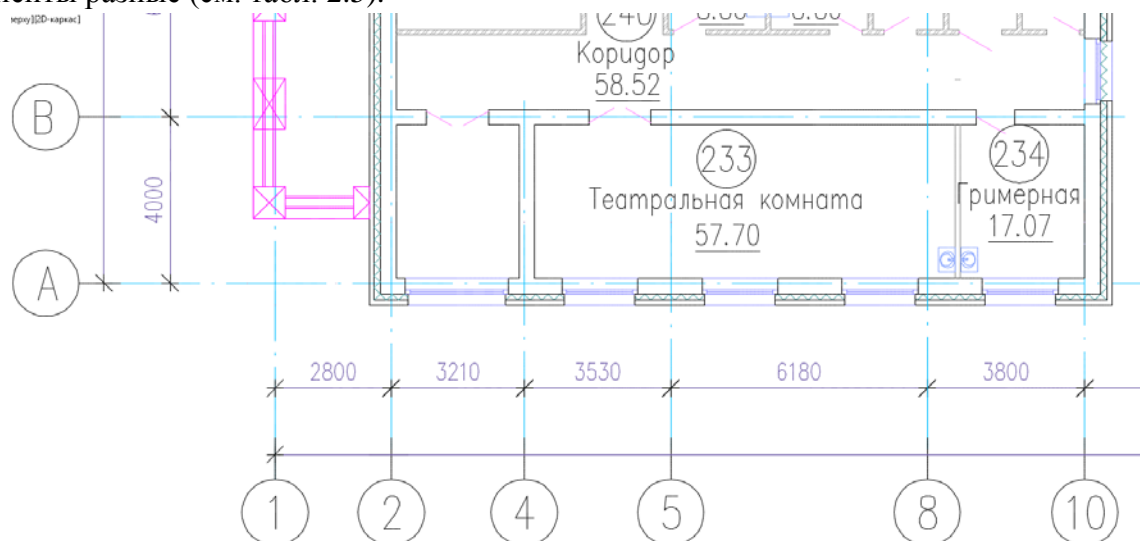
К определению грузовой площади перекрытий для стены по оси А в осях 4 – 8
